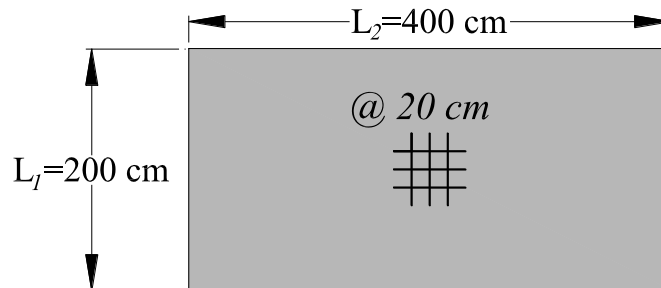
Vista en planta de la losa rectangular simplemente apoyada
